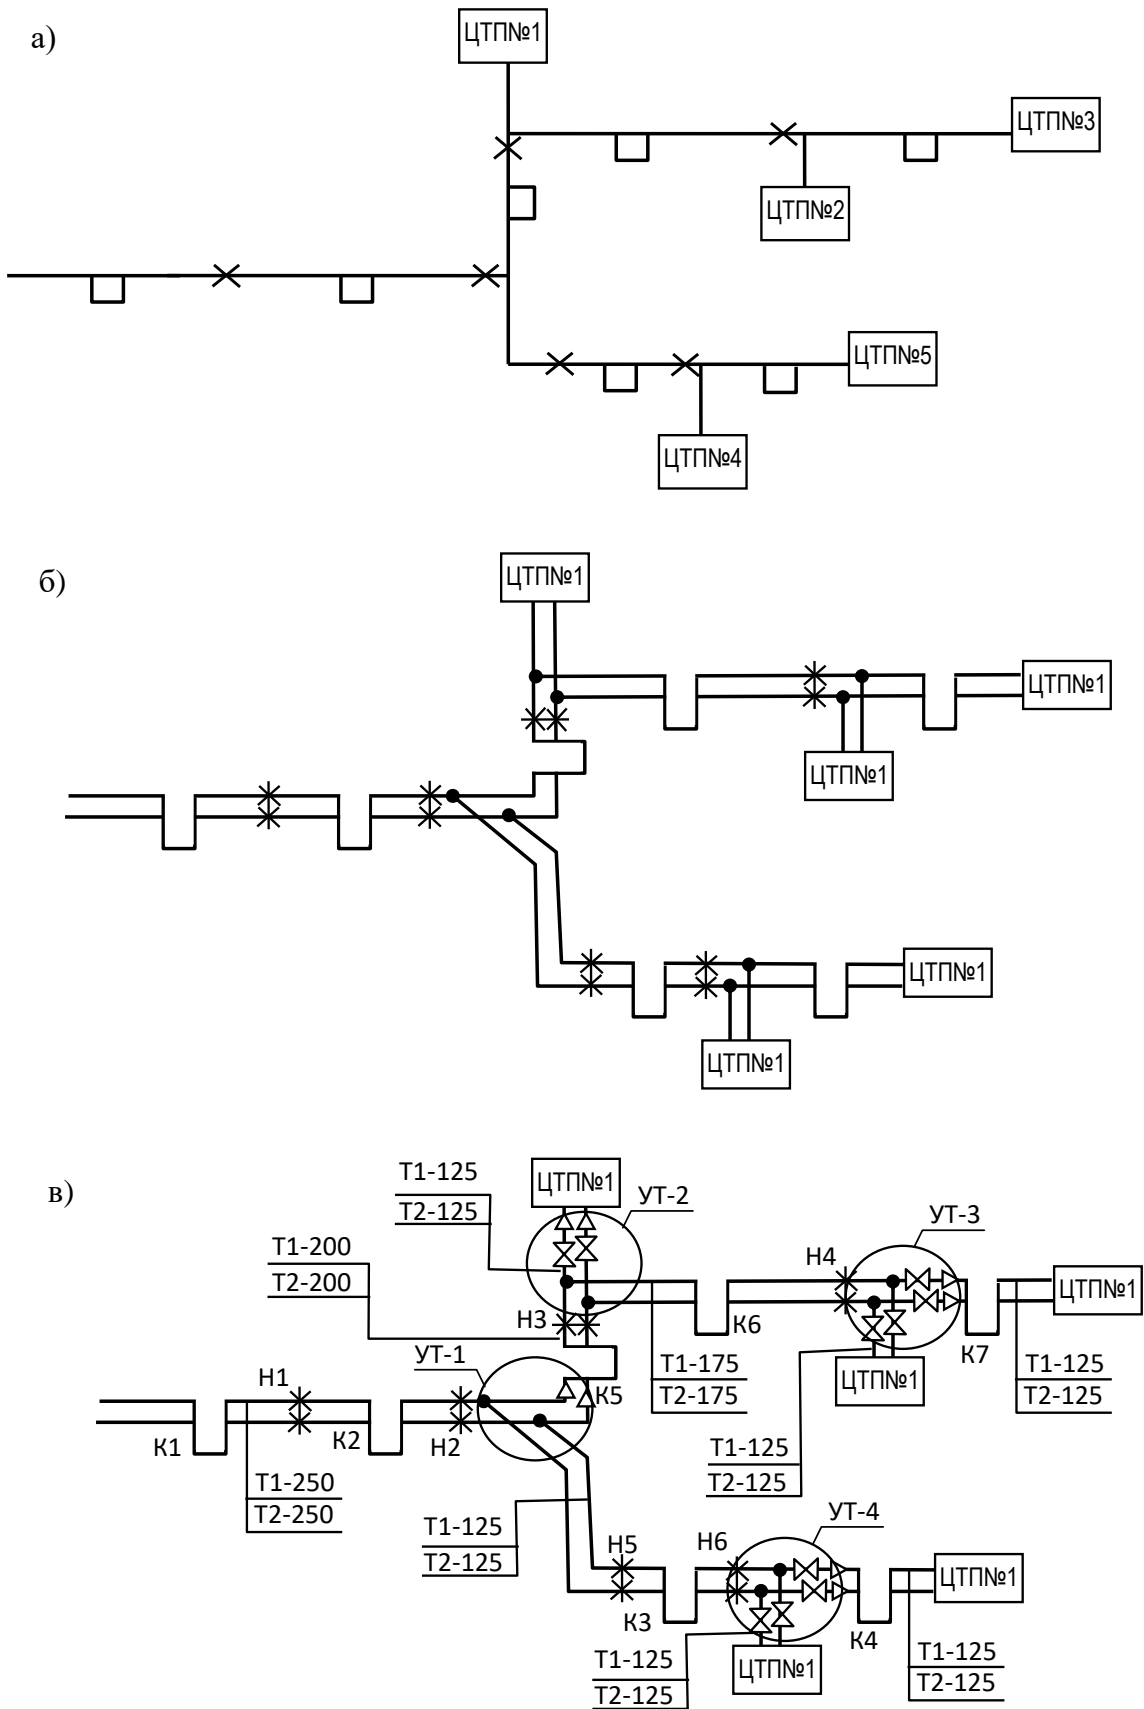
Основные этапы разработки монтажной схемы тепловой сети
